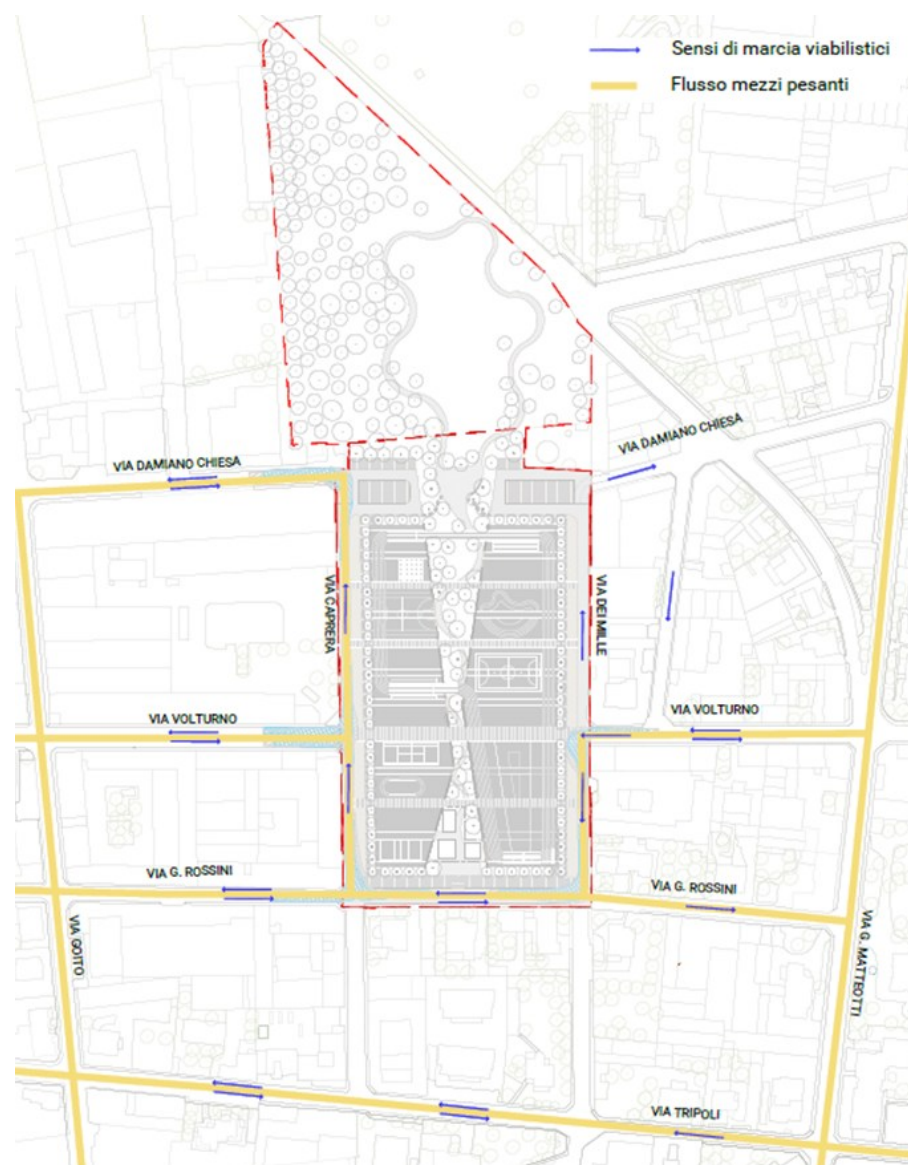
Planimetria riqualificazione area Piazzale Umiliati
